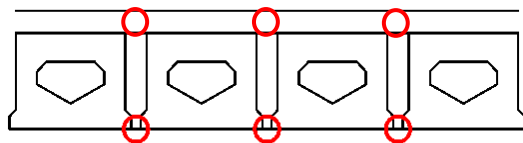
間詰め部の漏水やひび割れ（断面図）
